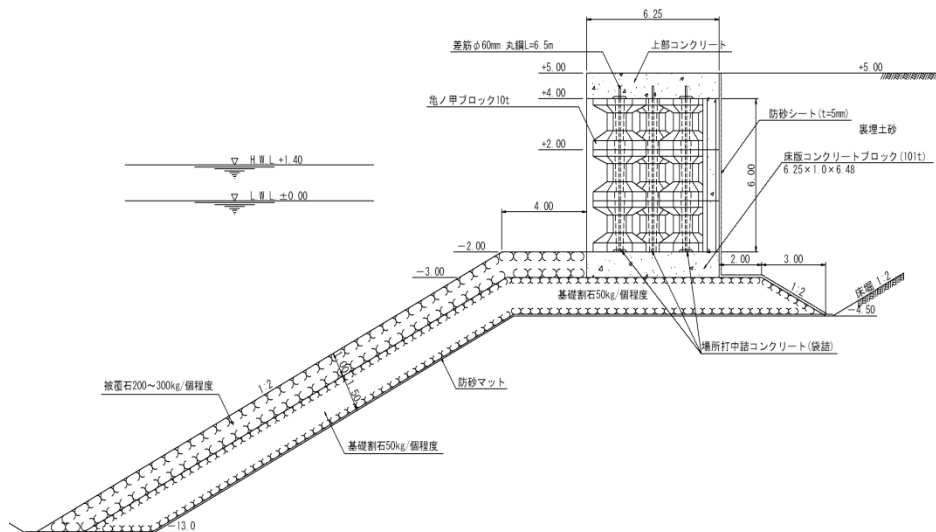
No. 3 中央船溜消波護岸の標準断面図（被災前）
